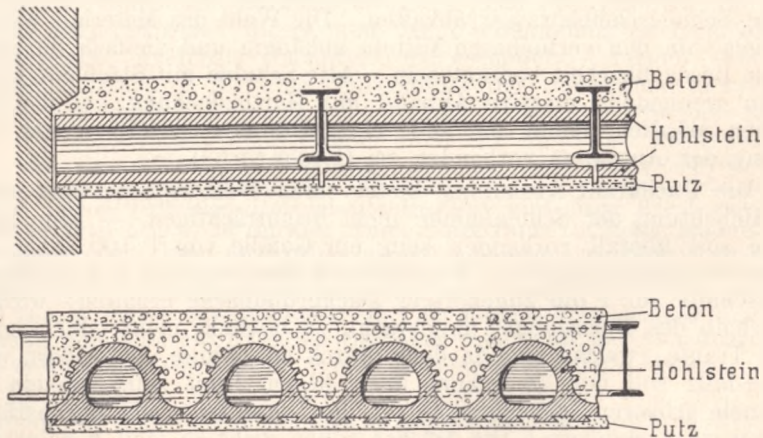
Eiserne Deckenkonstruktion mit gepreßten Hohlsteinen. Nach Fawcett aus Emmerich l. c.
